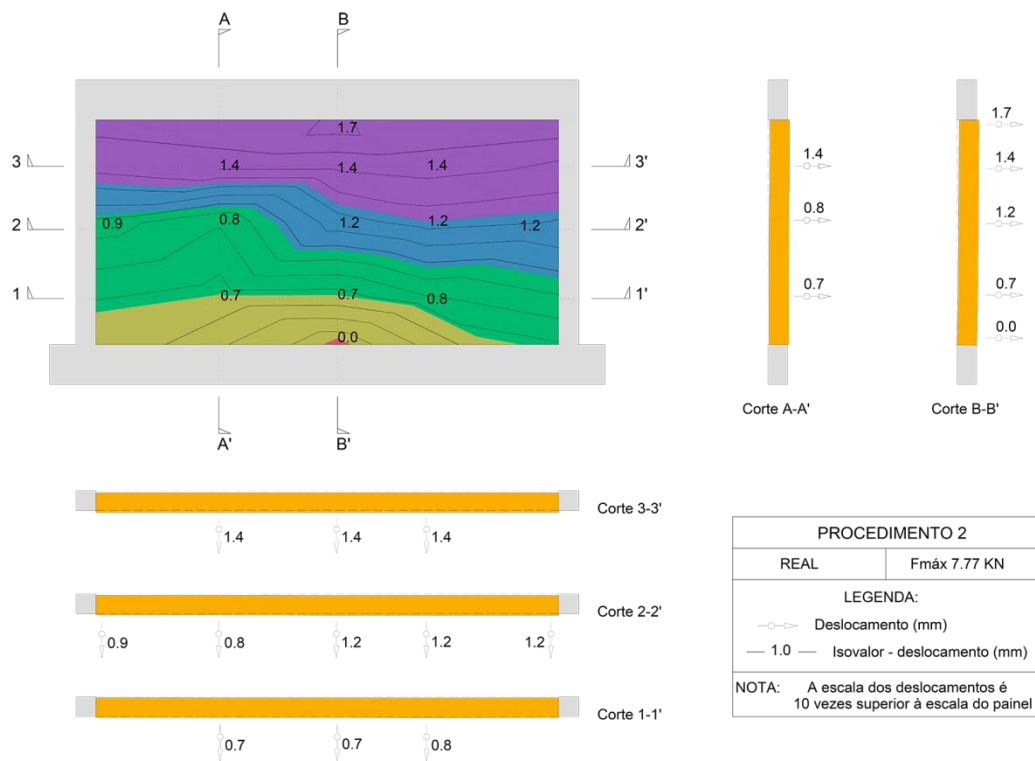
Isovalores da parede ensaiada - Procedimento 2. Ensaio fora do plano, Wall_RAR_01.
